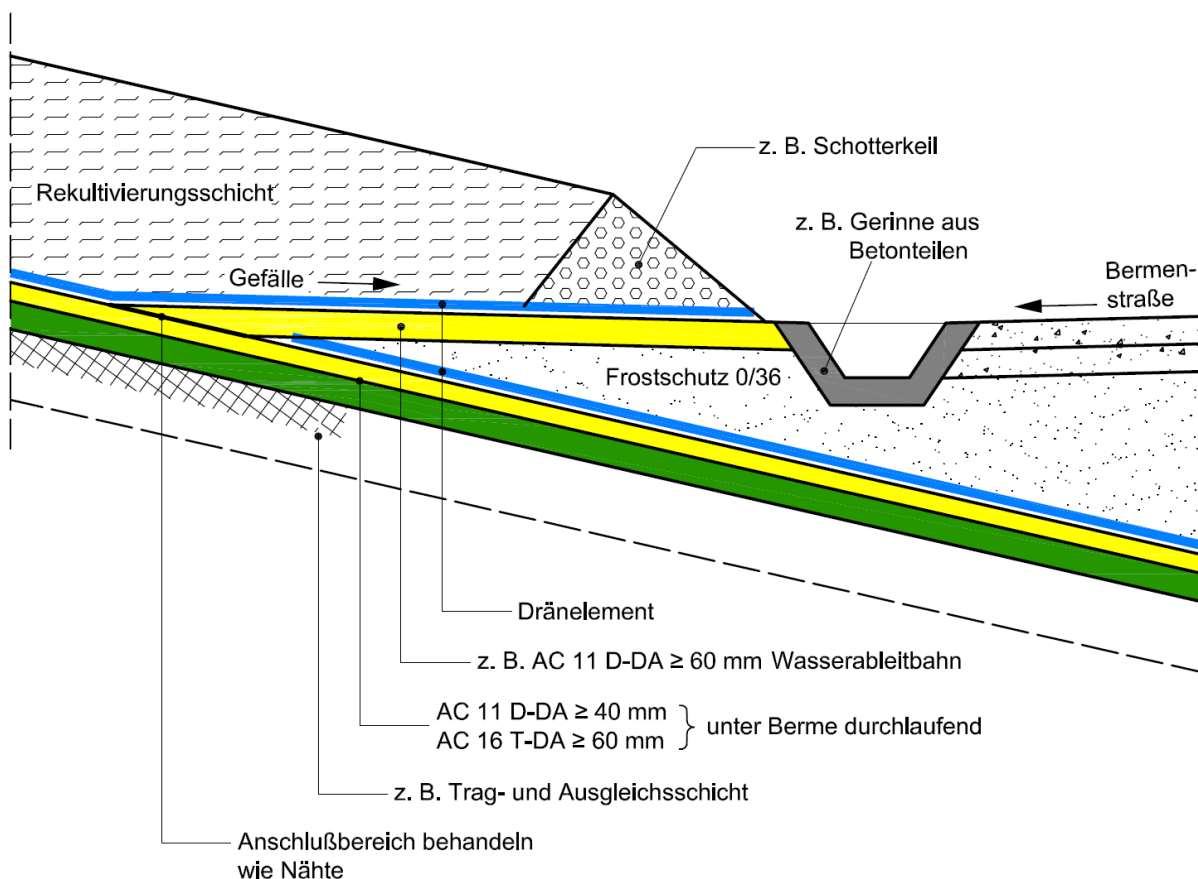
Beispielhafte Skizze zur Gestaltung einer Oberflächenabdichtungskomponente aus Deponieasphalt mit Anordnung einer Berme und Oberflächenwasserzwischenableitung
